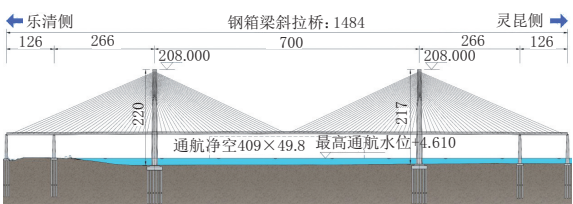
公铁合建斜拉桥主桥立面布置图(单位:m)
